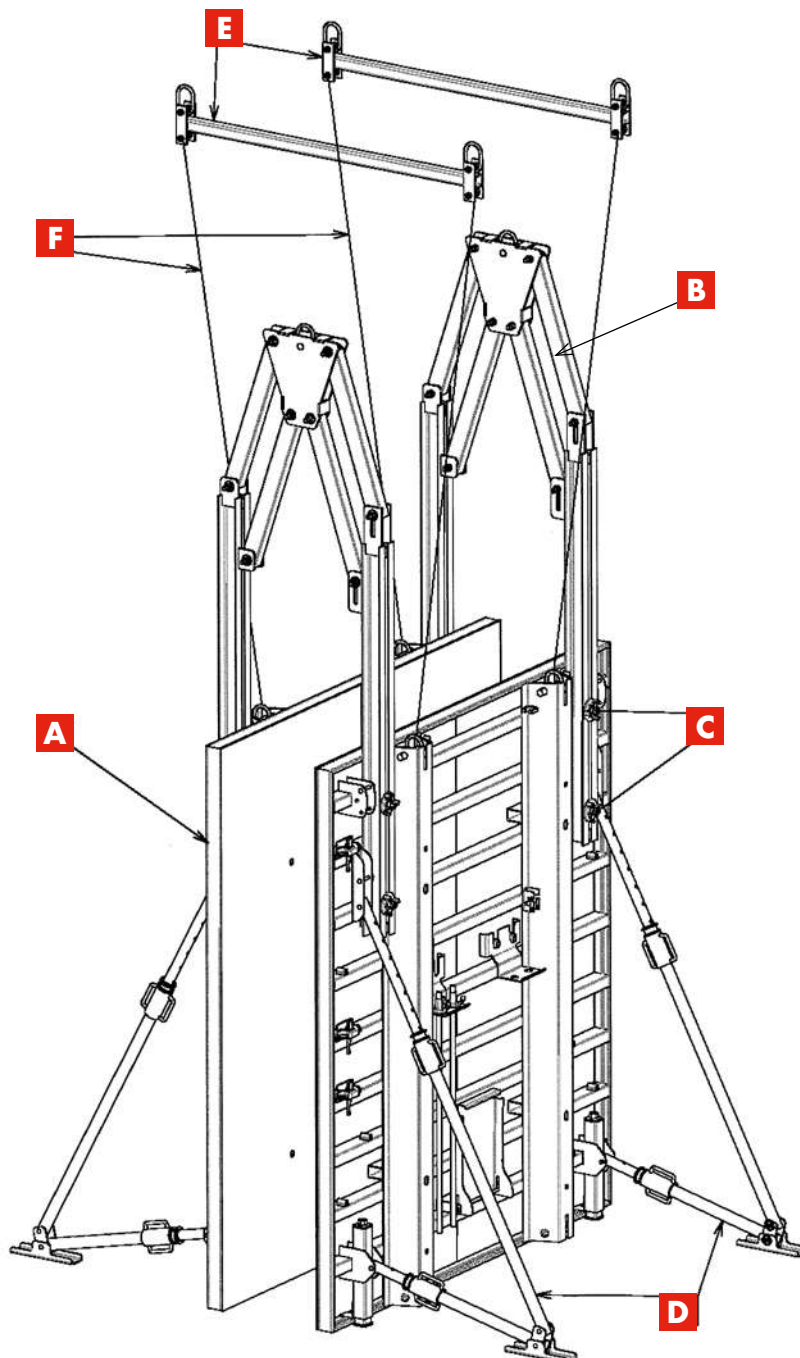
bis: Stabilisation banches ELPAC superposées hauteur 7,00 m
